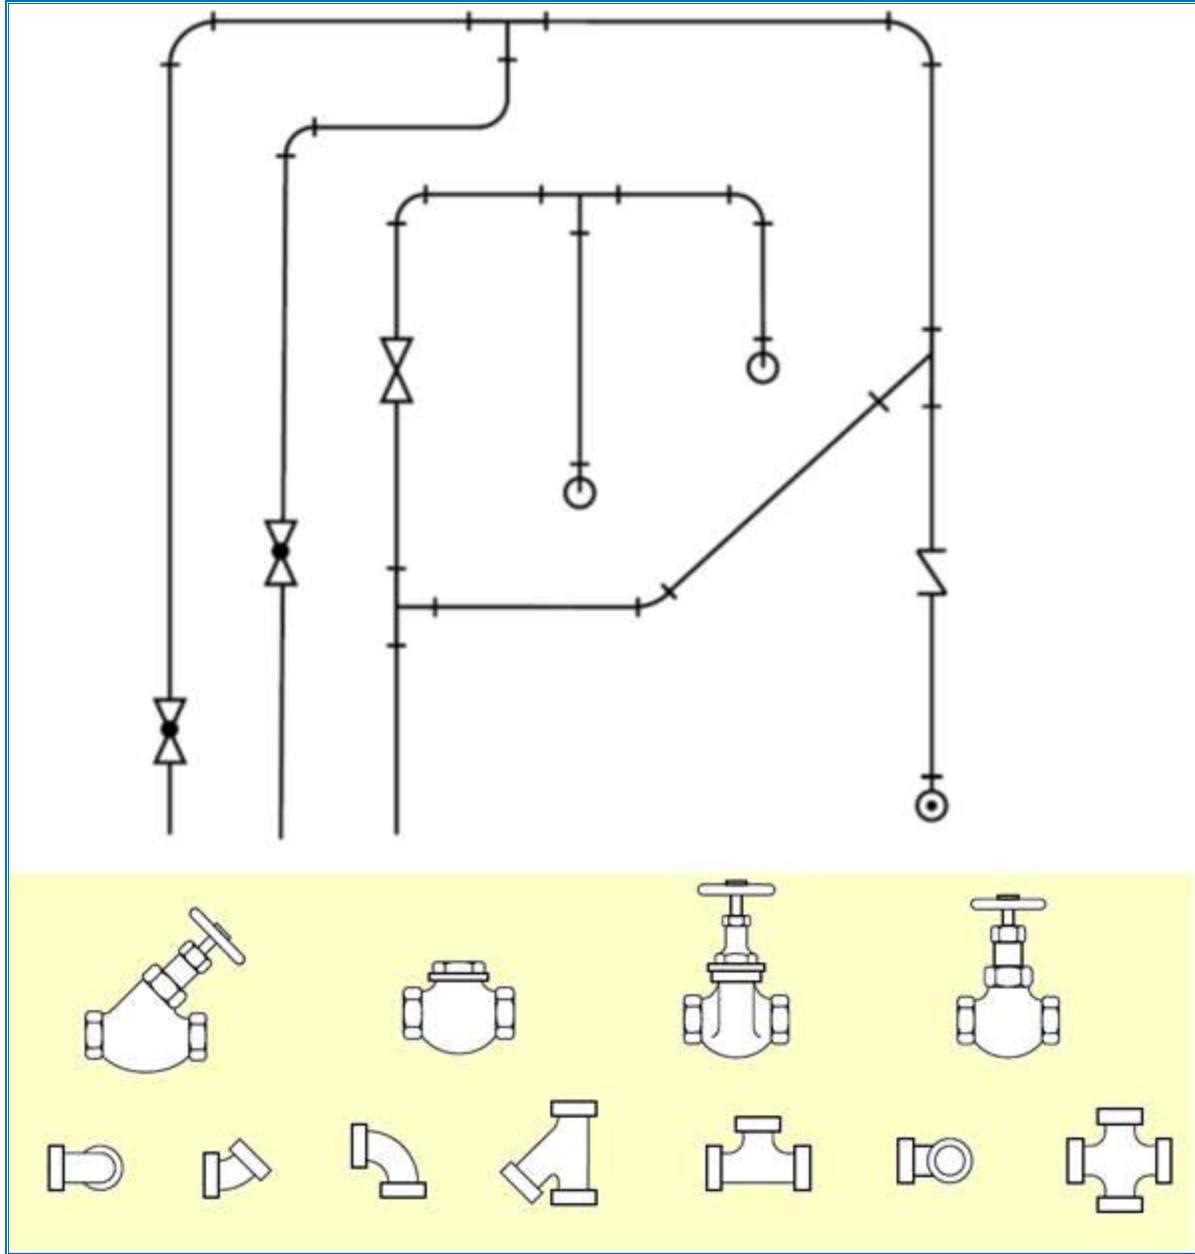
أ مسقط أفقي لشبكة أنابيب
